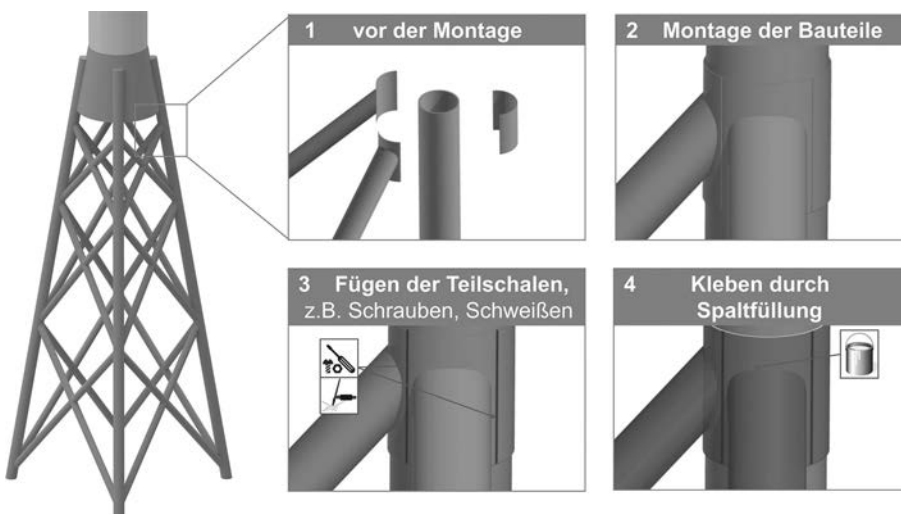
Konzept Stahlfachwerkkonstruktion mit geklebtem Strebenanschluss [53]
